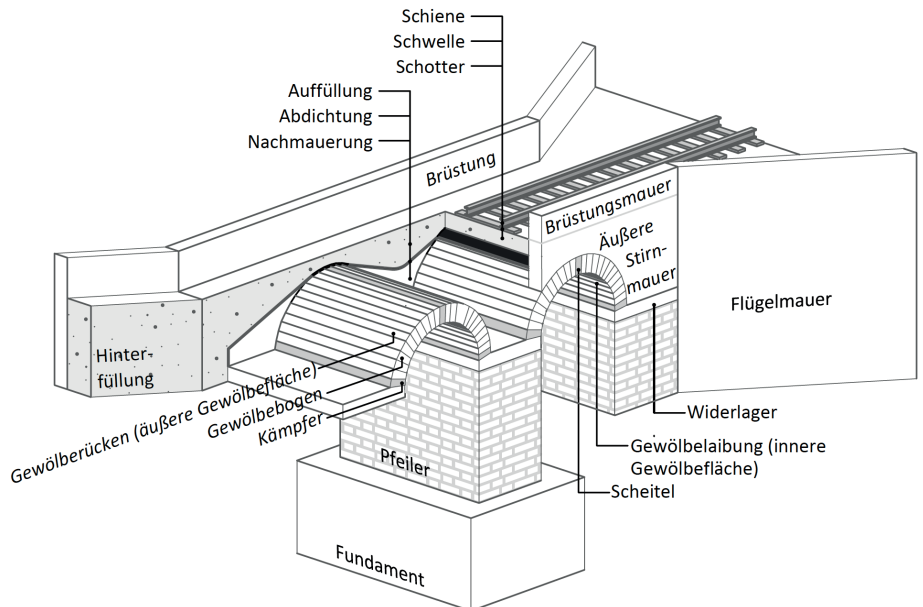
Grundsätzliche Elemente einer Eisenbahngewölbebrücke, nach [2]
